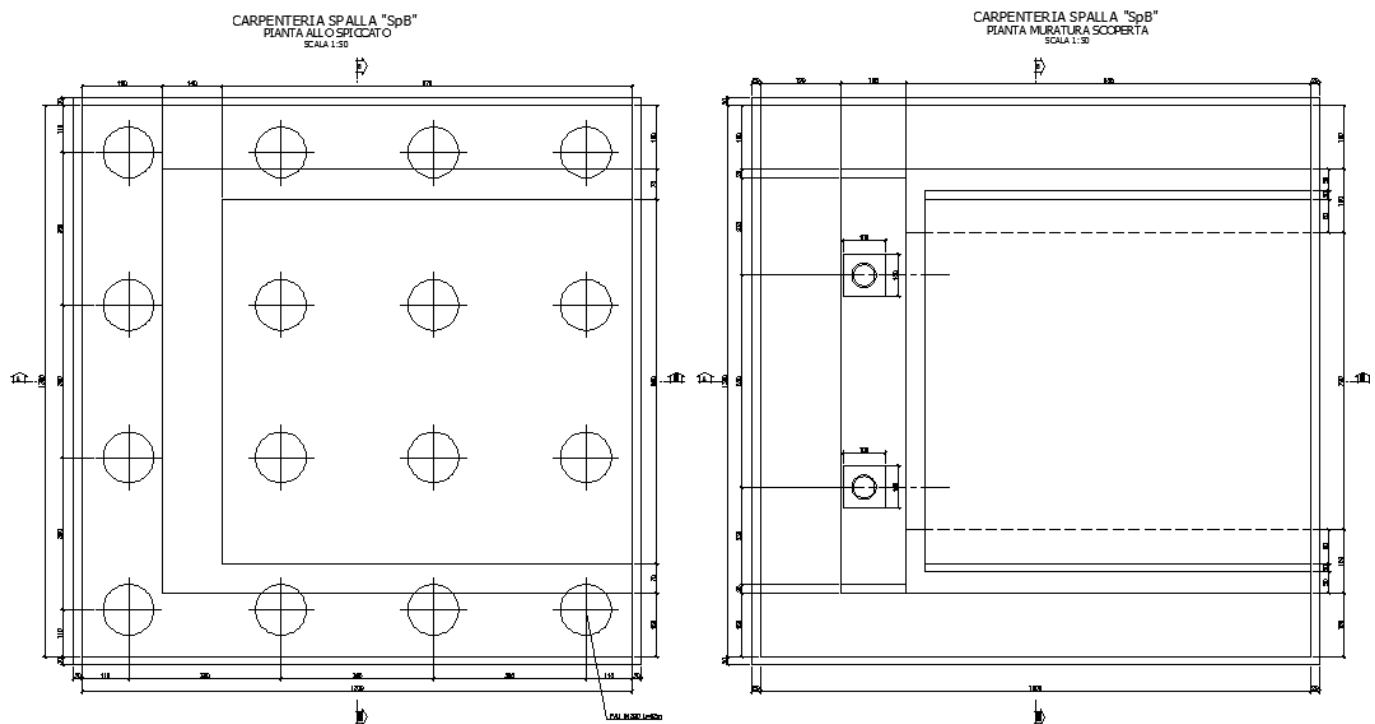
Pianta e pianta fondazioni spalla B.
